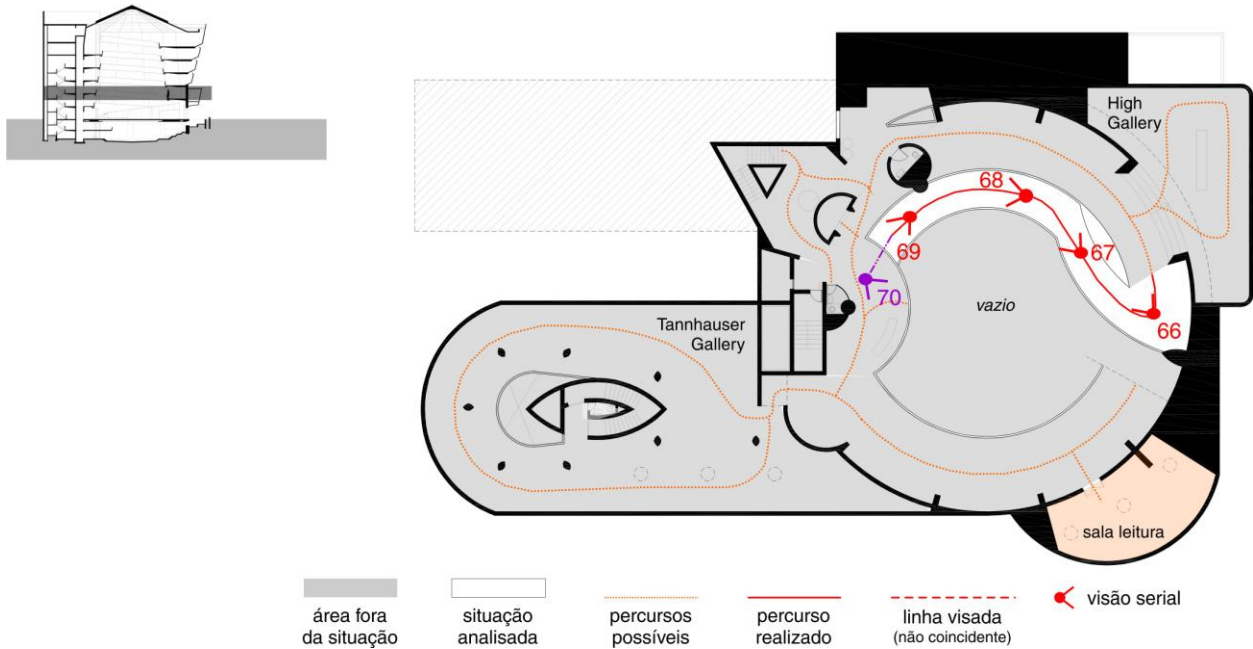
| Guggenheim – Planta Primeiro Pavimento | Desenho da Autora
